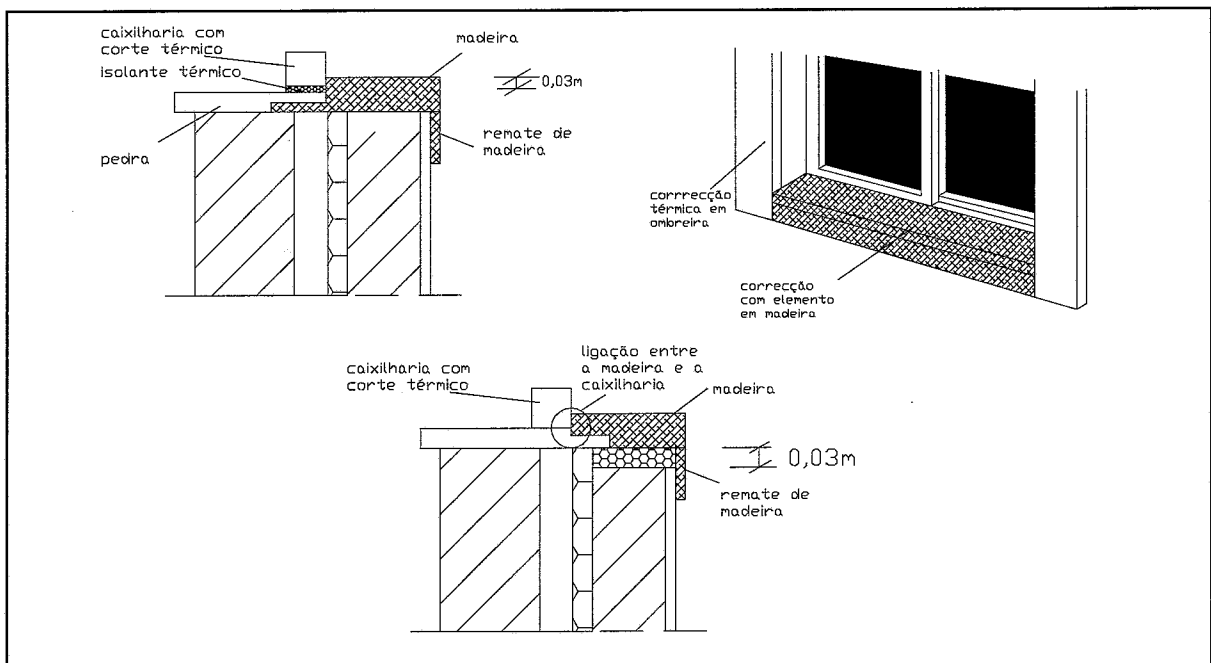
Pormenor da correcção de ponte térmica em zona de parapeito substituição parcial da pedra de parapeito
